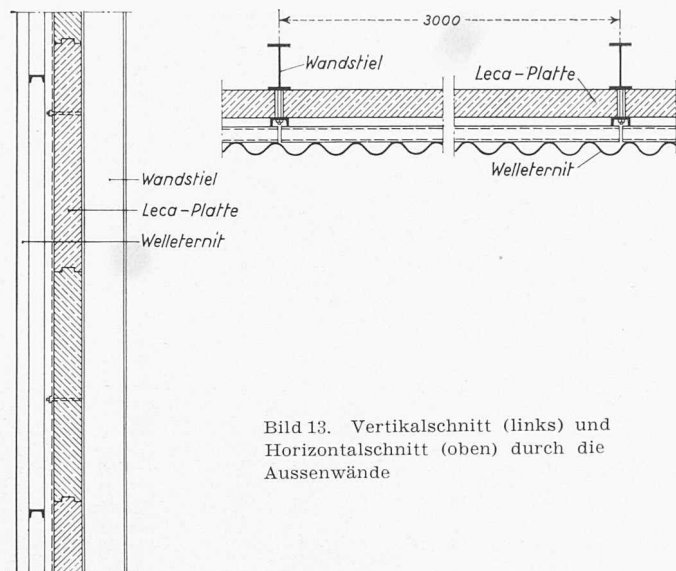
Vertikalschnitt (links) und Horizontalschnitt (oben) durch die Aussenwände
